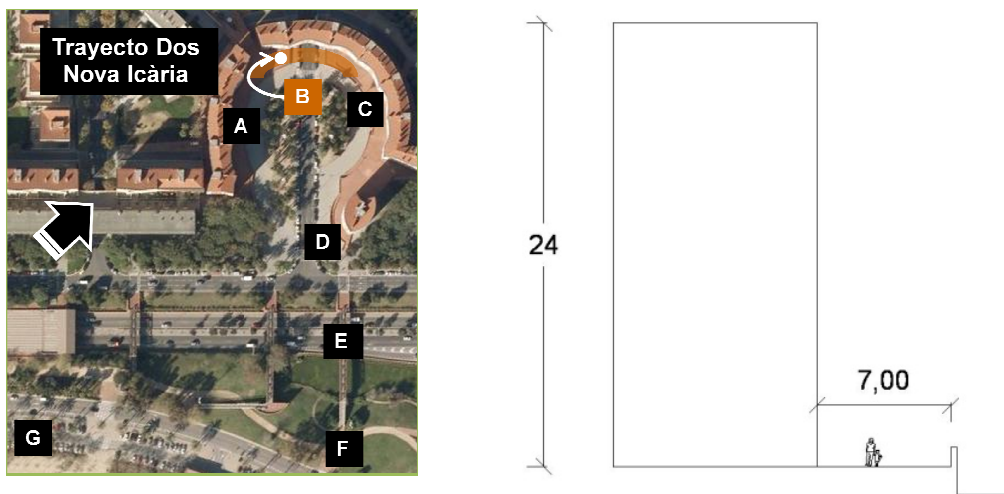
Planta y corte de la circulación peatonal B, frente a fachada Sureste. Trayecto Dos, Nova Icaria.
